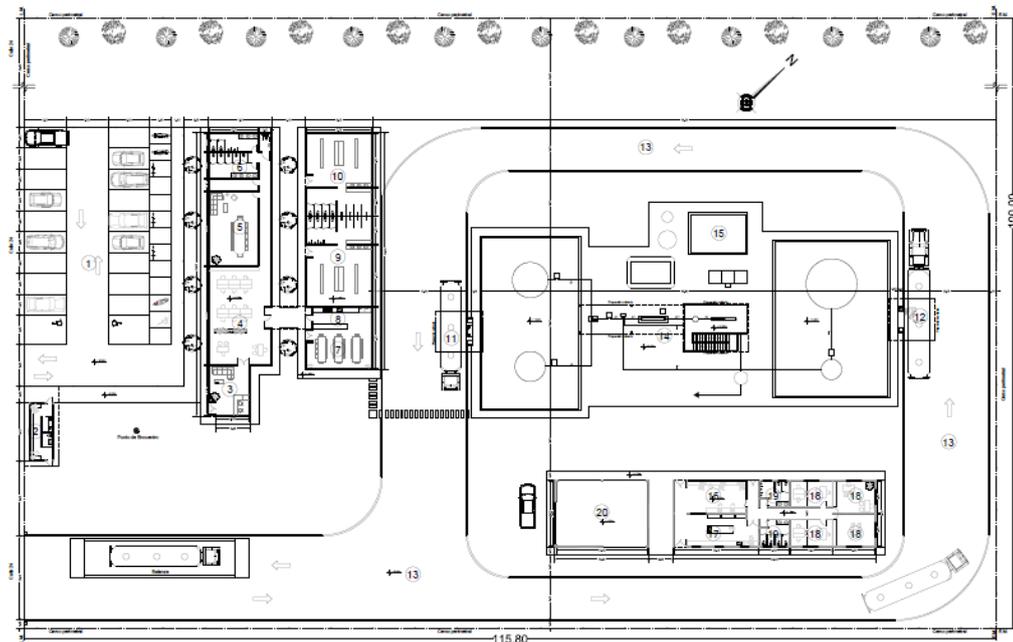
Plano general de la planta. Fuente: Elaboración propia.
